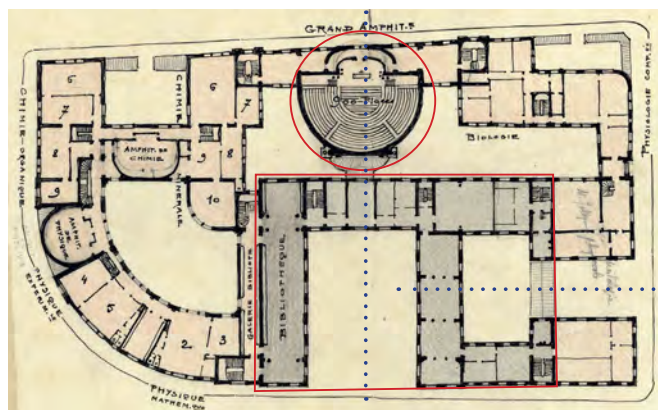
20 世紀初頭頃の平面図 (ギルバートによる復元)
